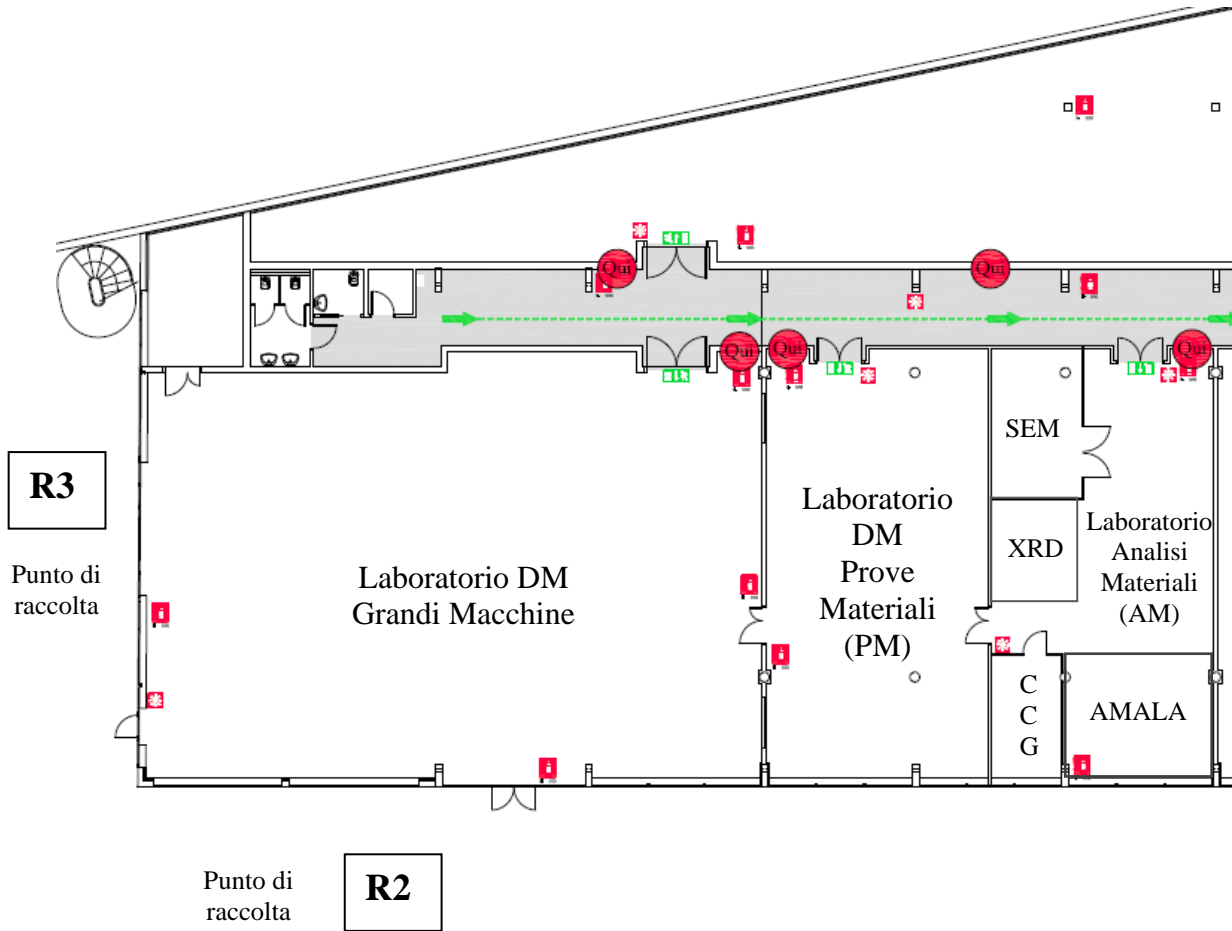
Pianta dell'edificio B13 - Piano Terra (Parte II)
